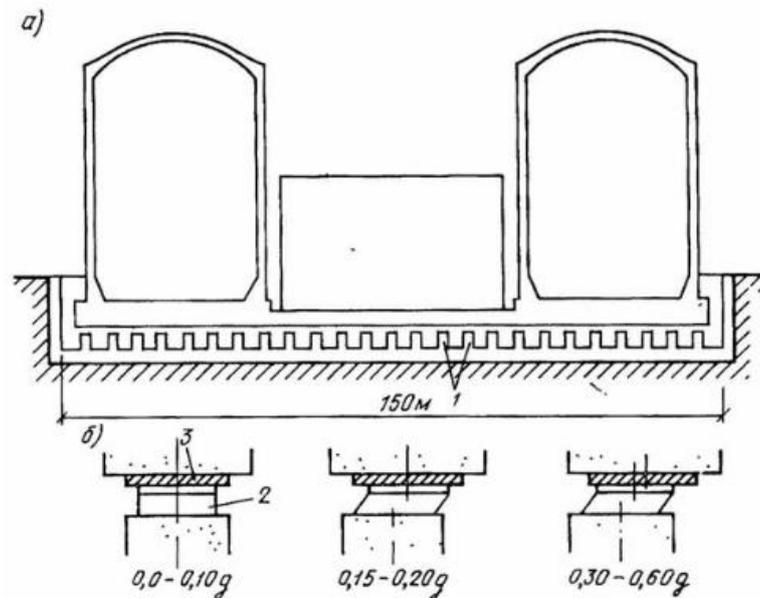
Сейсмоизоляция атомной электростанции «Коеберг»: (а) Конструктивная схема; (б) Схема работы фрикционной опоры при различных нагрузках; 1 – фрикционные фундаментные опоры; 2 – упругая подушка из армированного неопрена; 3 – фрикционные пластины
